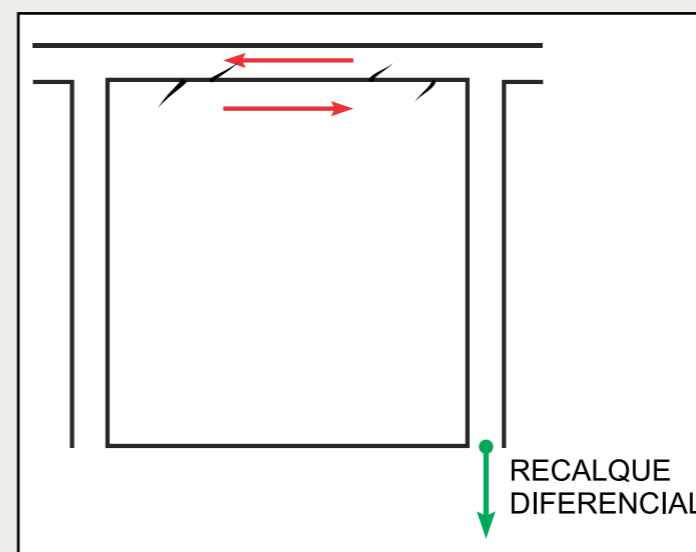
Tensões tangenciais entre viga e parede (trinca única com ramais)
